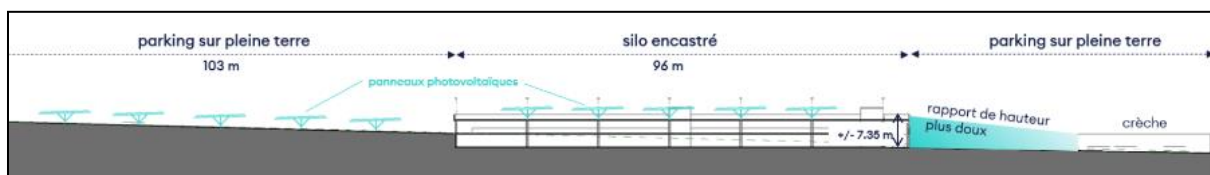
Coupe longitudinale des espaces de parkings (source : assar architects)
